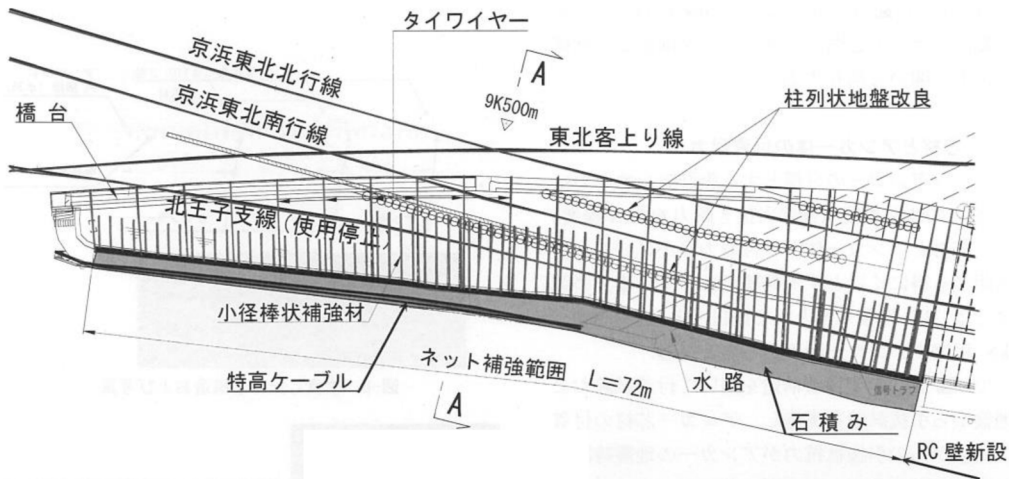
ネット補強工法の適用事例（平面図）⁶⁾
